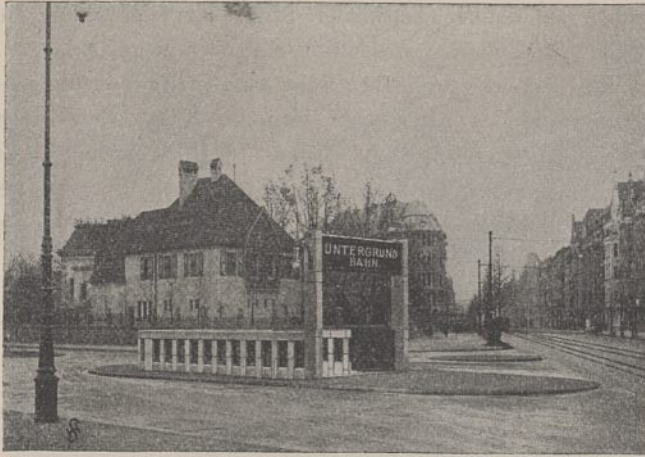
Eingang zur Haltestelle Hauptstraße.
